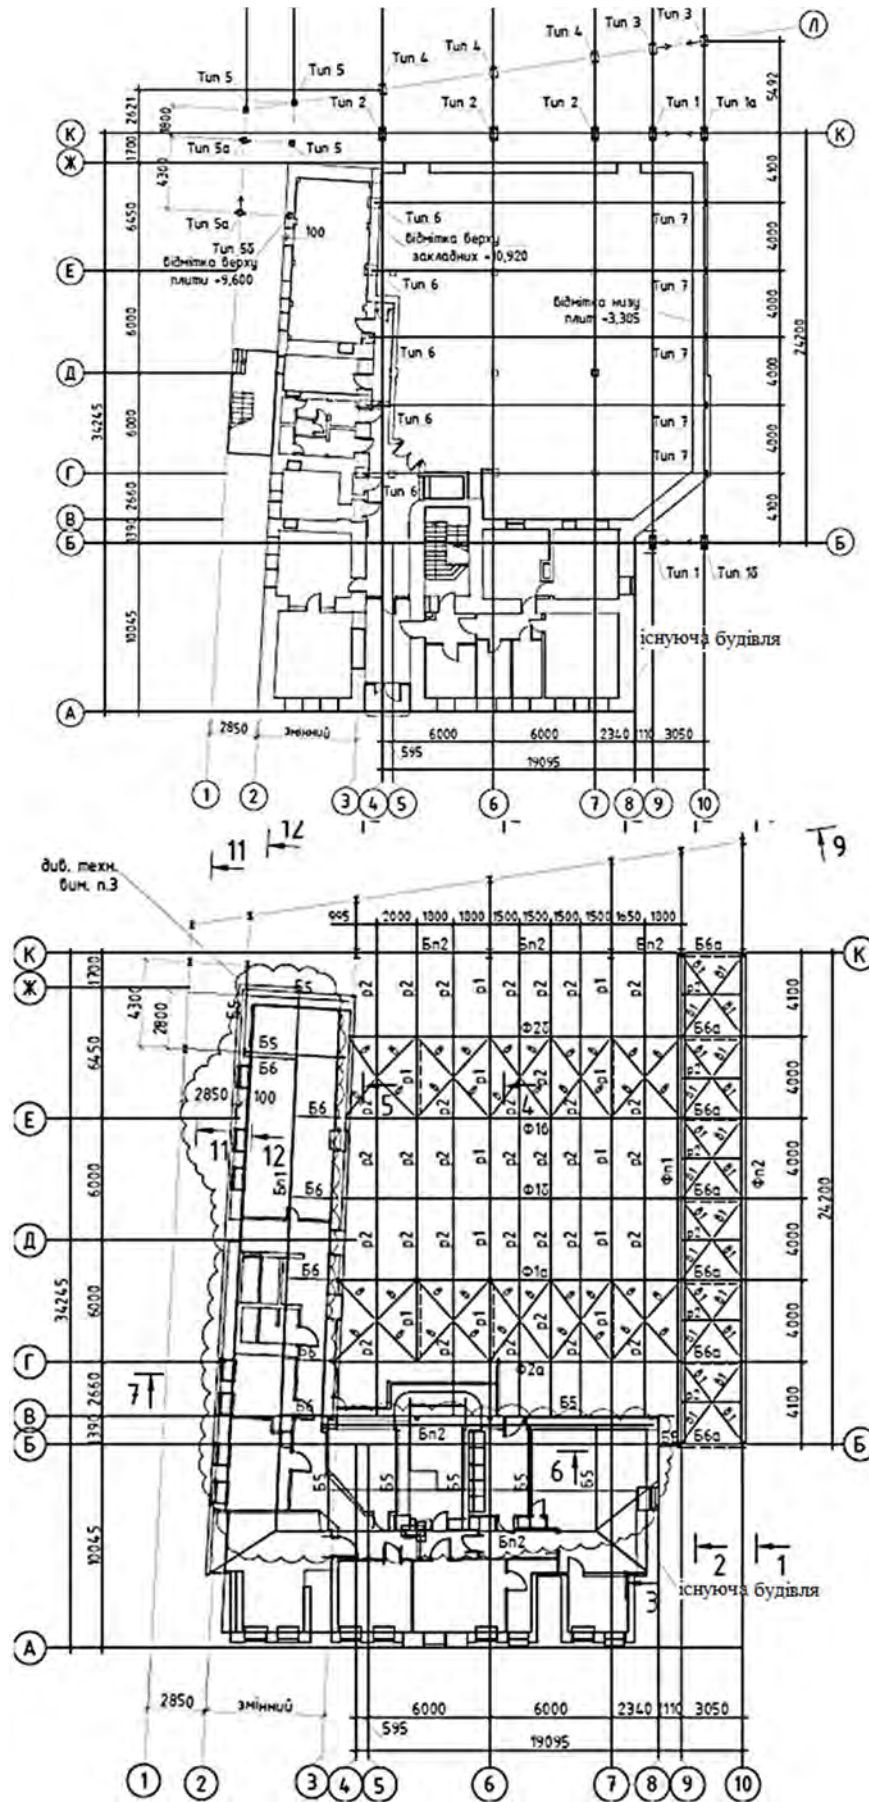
Схема розташування баз колон та металевих конструкцій по верхнім поясам ферм
